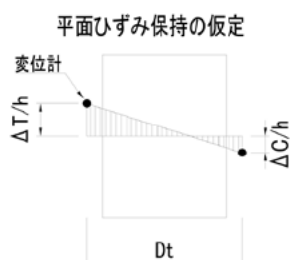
変位計配置図 [参考文献¹⁰⁾]
